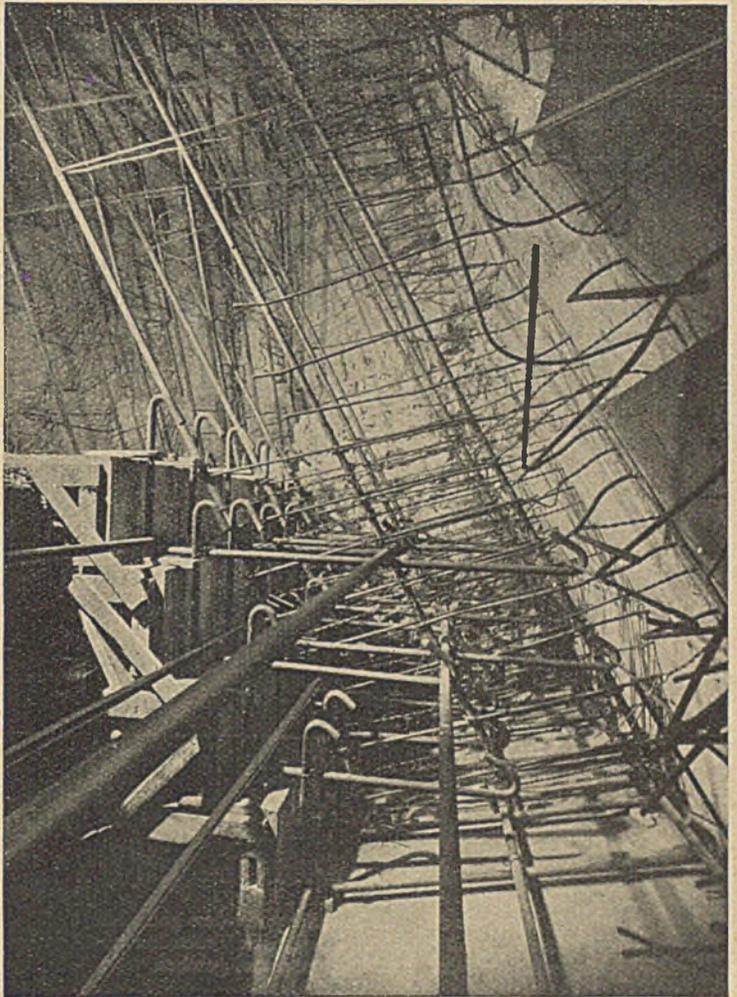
Bewehrung und Einschalung eines Schemelfußes.
